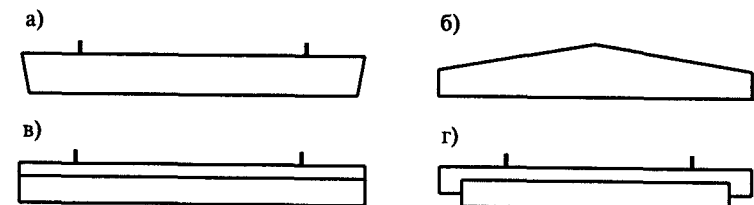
Вид железобетонных балок в зависимости от опирания на нижележащие конструкции: а); б) на кирпичные стены или консоли колонн сверху; в) на верхний торец (обрез) колонны или верх стены; г) на консоль колонны — подрезкой, скрывающей консоль
